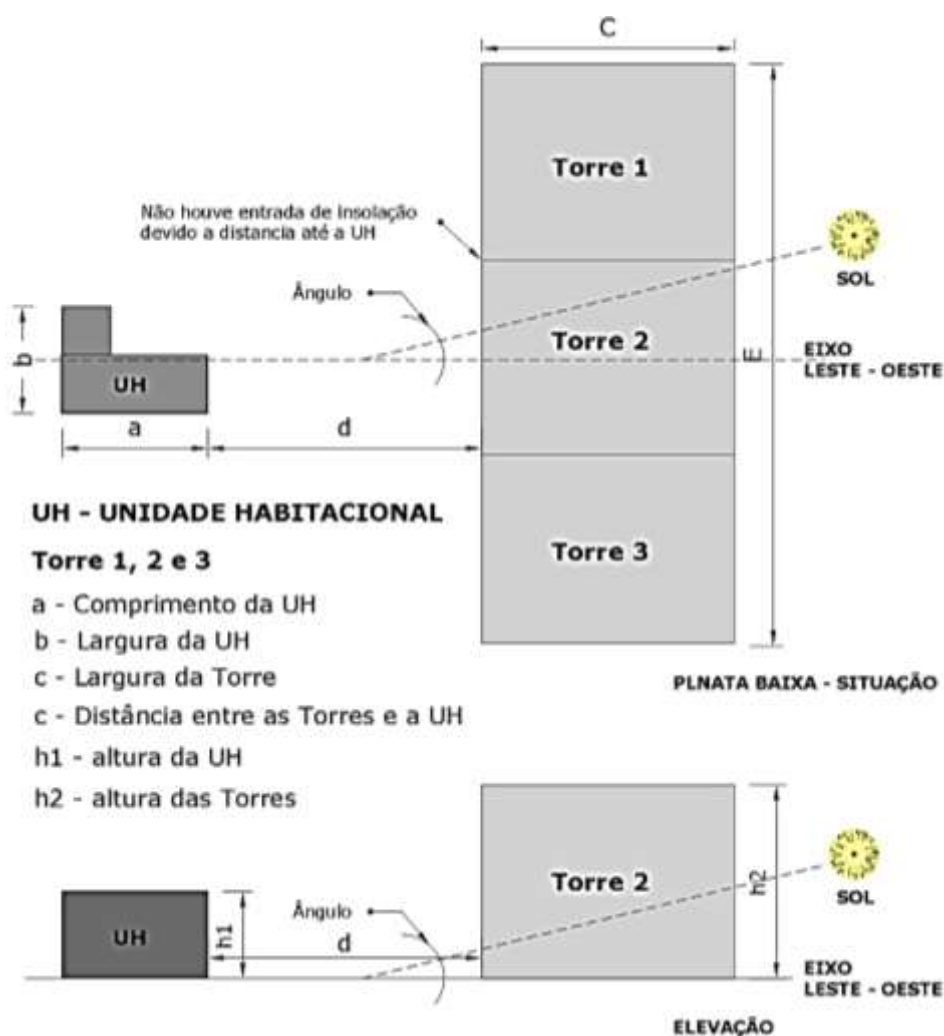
Planta Baixa e Elevação – Análise de sombreamento
